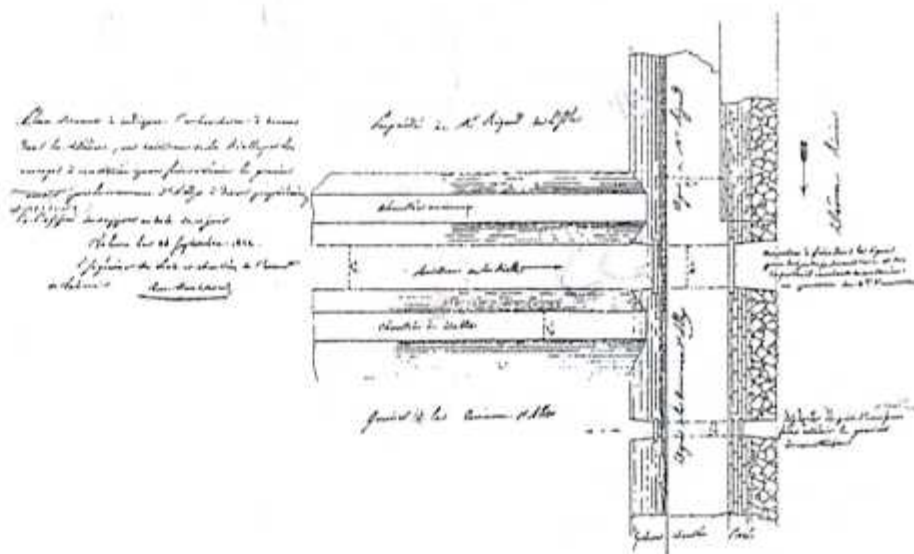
Plan à l'appui du rapport de l'ingénieur Montrond - (Source : A.D.D.)
